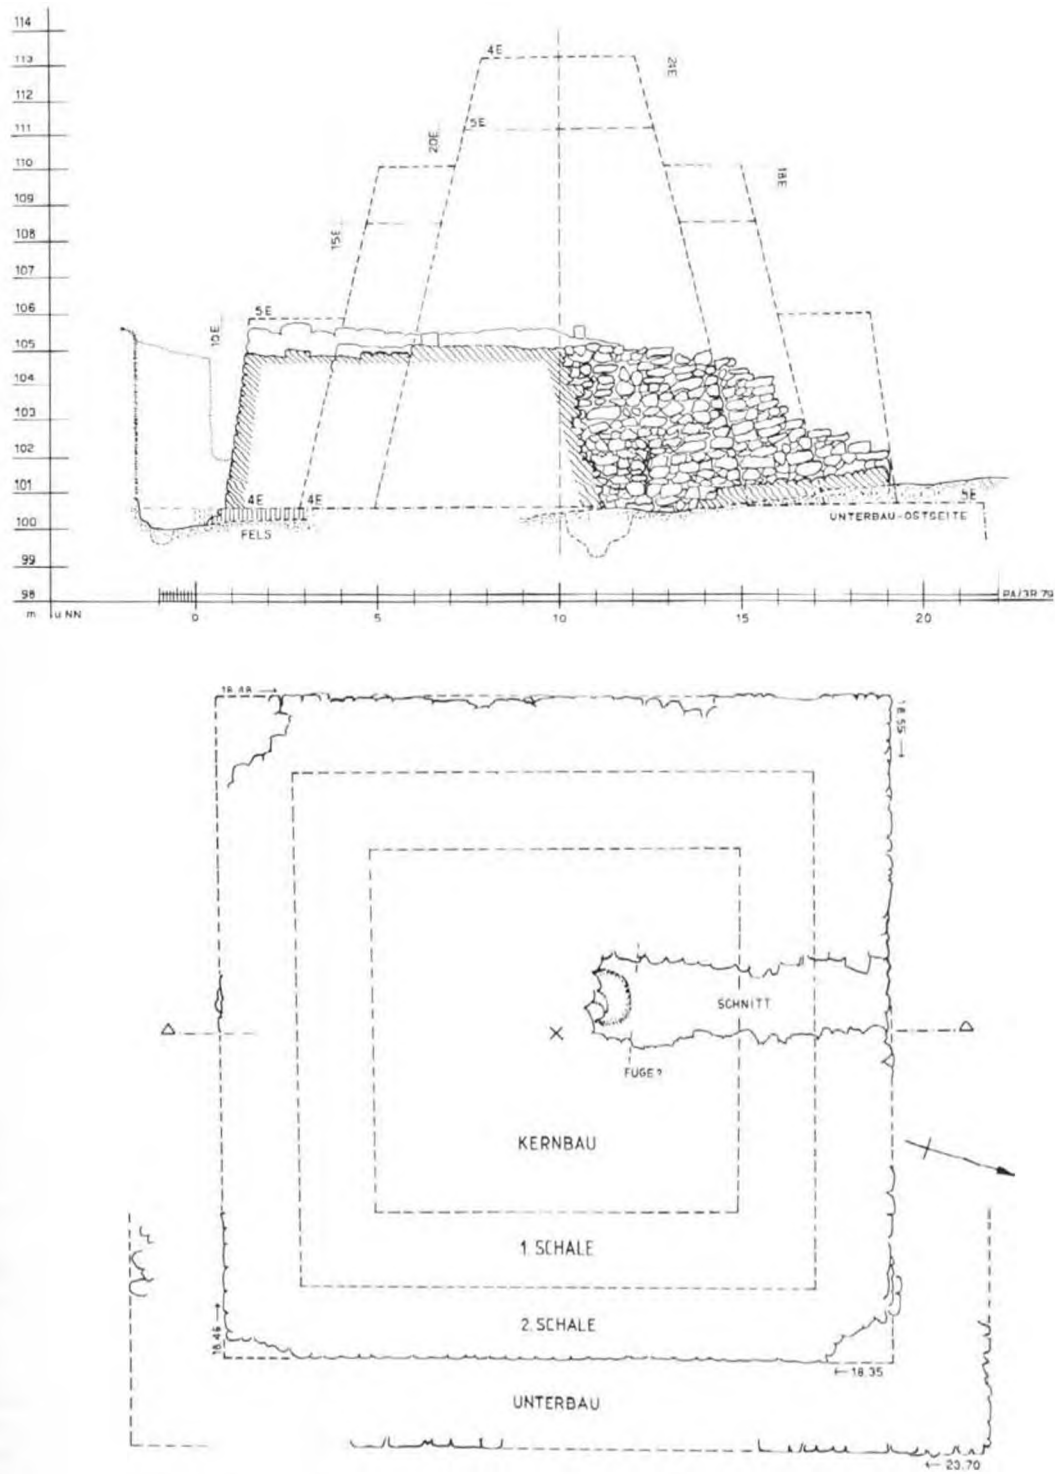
Pyramide, Schnitt (mit Rekonstruktionsmöglichkeiten) und Grundriß.
